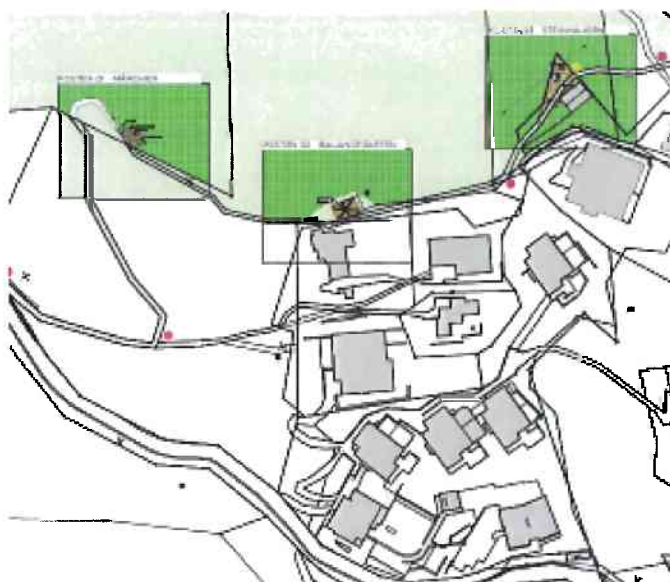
Ausschnitt Situationsplan Wolli - Erlebnisweg mit Stationen Teil 1, Büro Architektur & Design Zermatt
